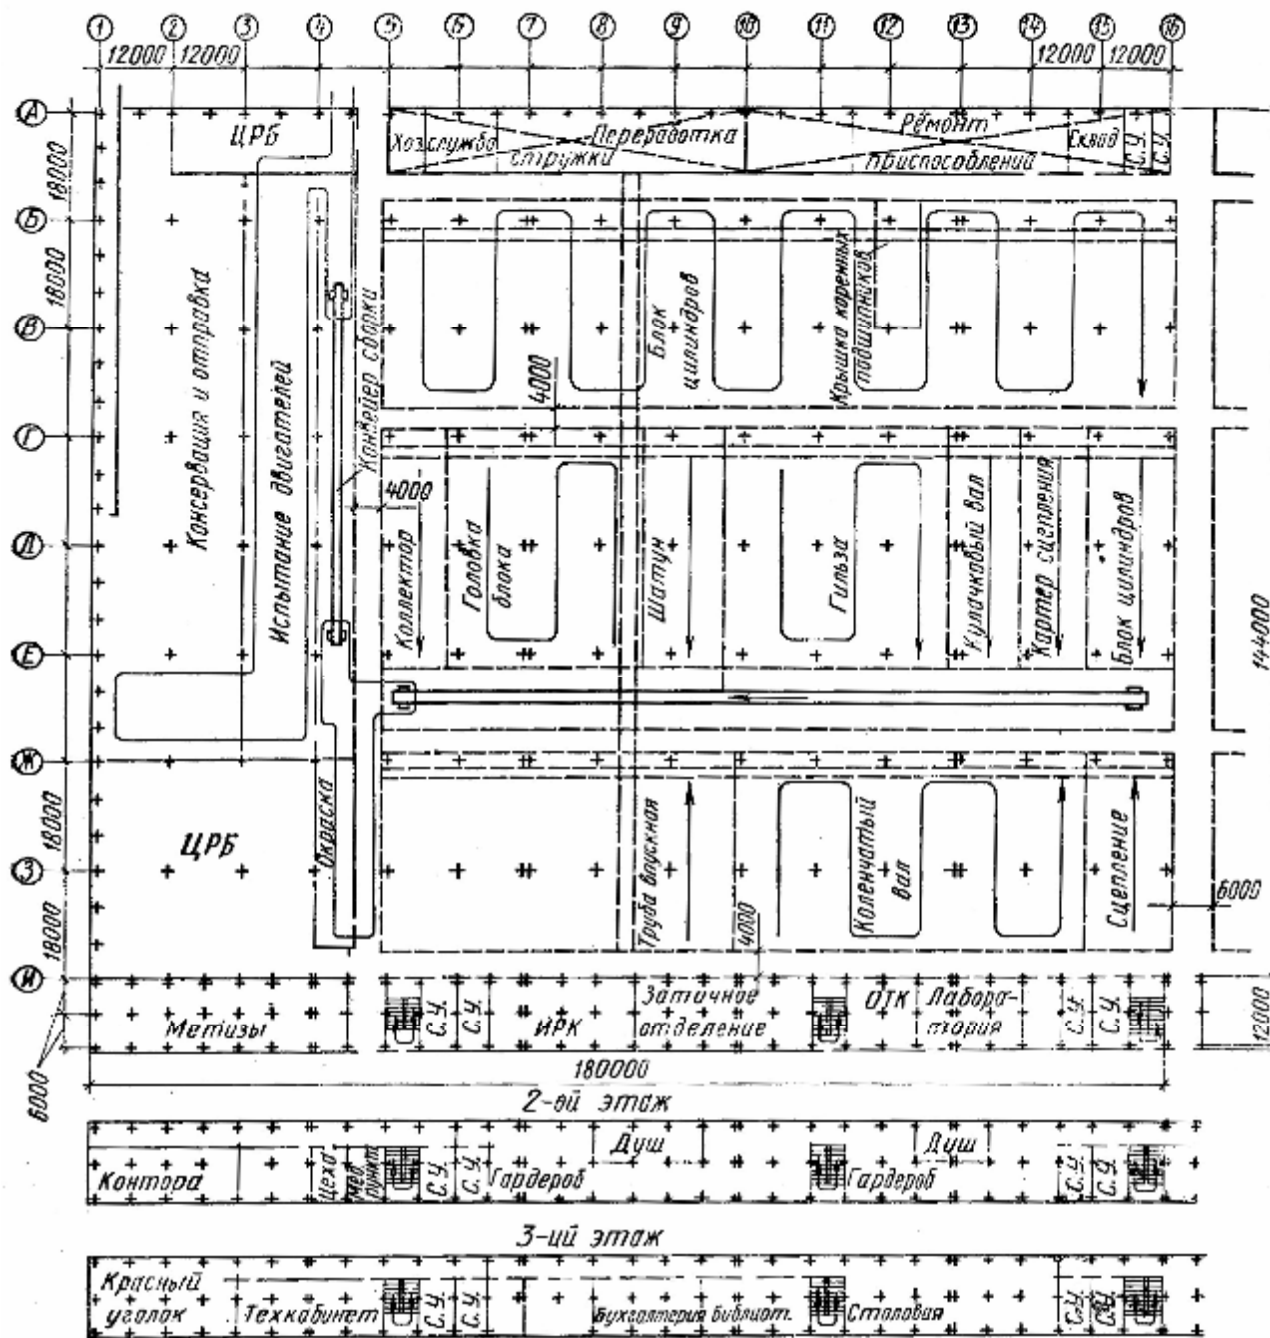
План механосборочного корпуса по производству двигателей грузового автомобиля
